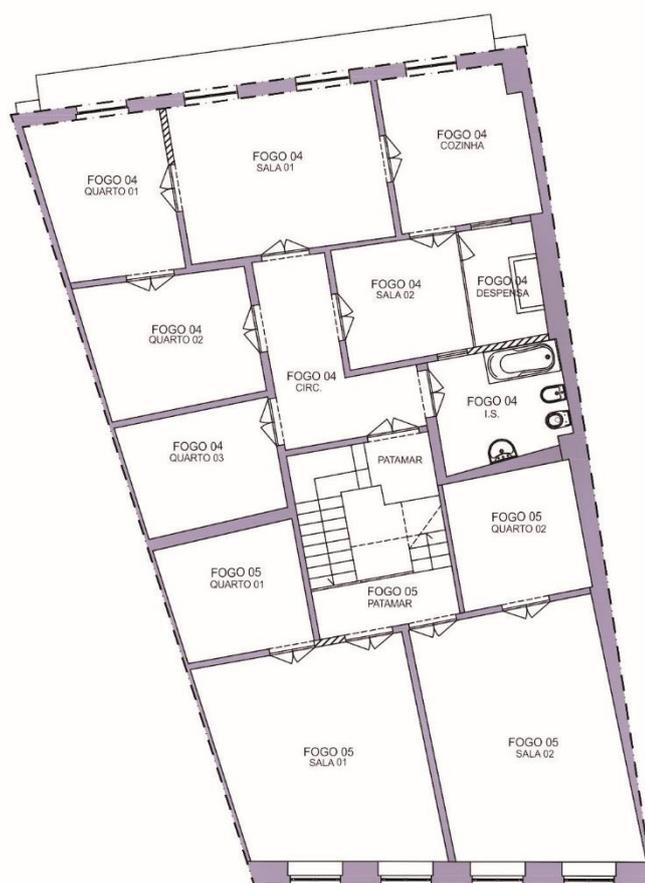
Planta 3º e 4º pavimentos (sem escala)
